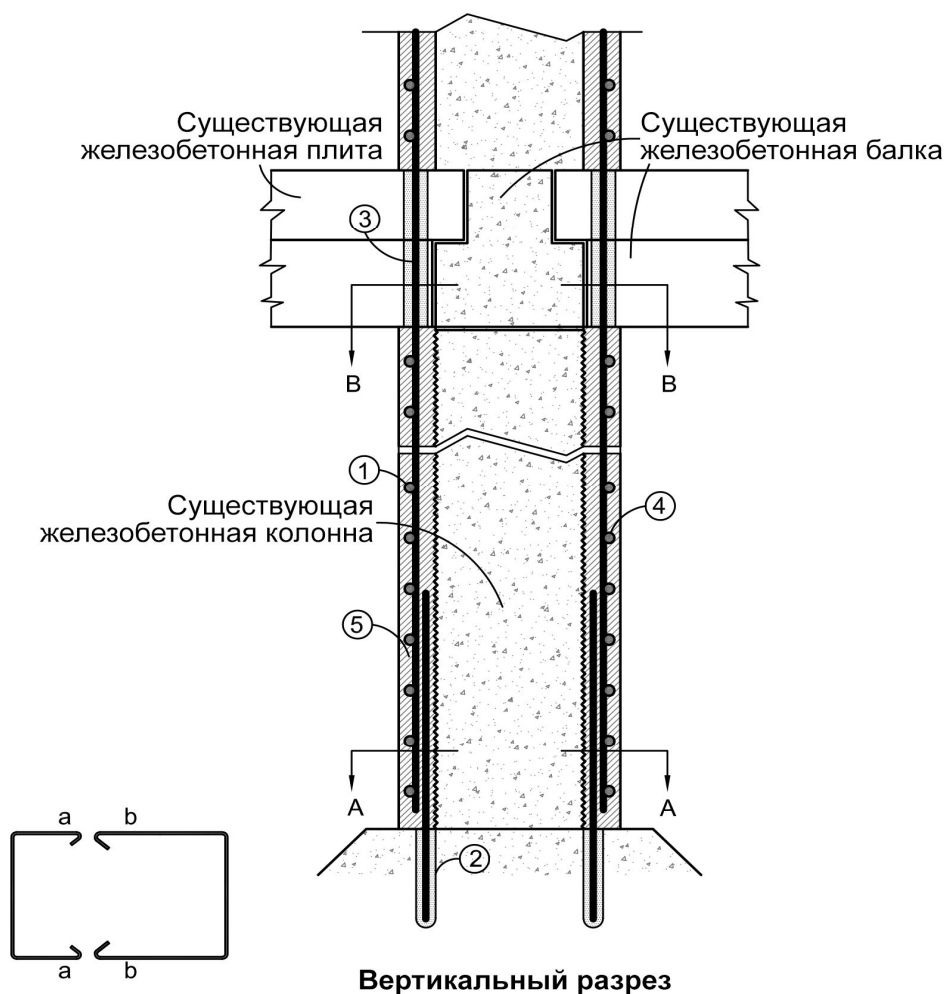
Схема сейсмоусиления колонны с железобетонными обоймами: 1 – продольная арматура обоймы (пучок из 3 стержней в каждом углу); 2 – крепление стержней в существующем фундаменте; 3 – отверстия, проделанные в существующей балке для обеспечения неразрывности арматуры обоймы; 4 – новые U-образные связи; 5 – новая железобетонная обойма
